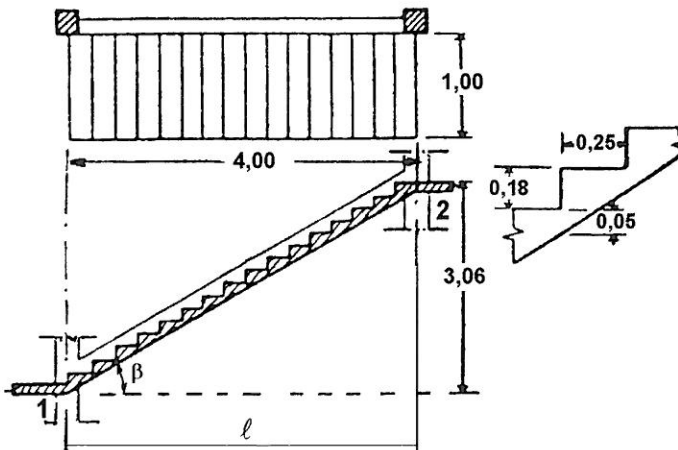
Escada em consola de uma viga inclinada 1, 2
